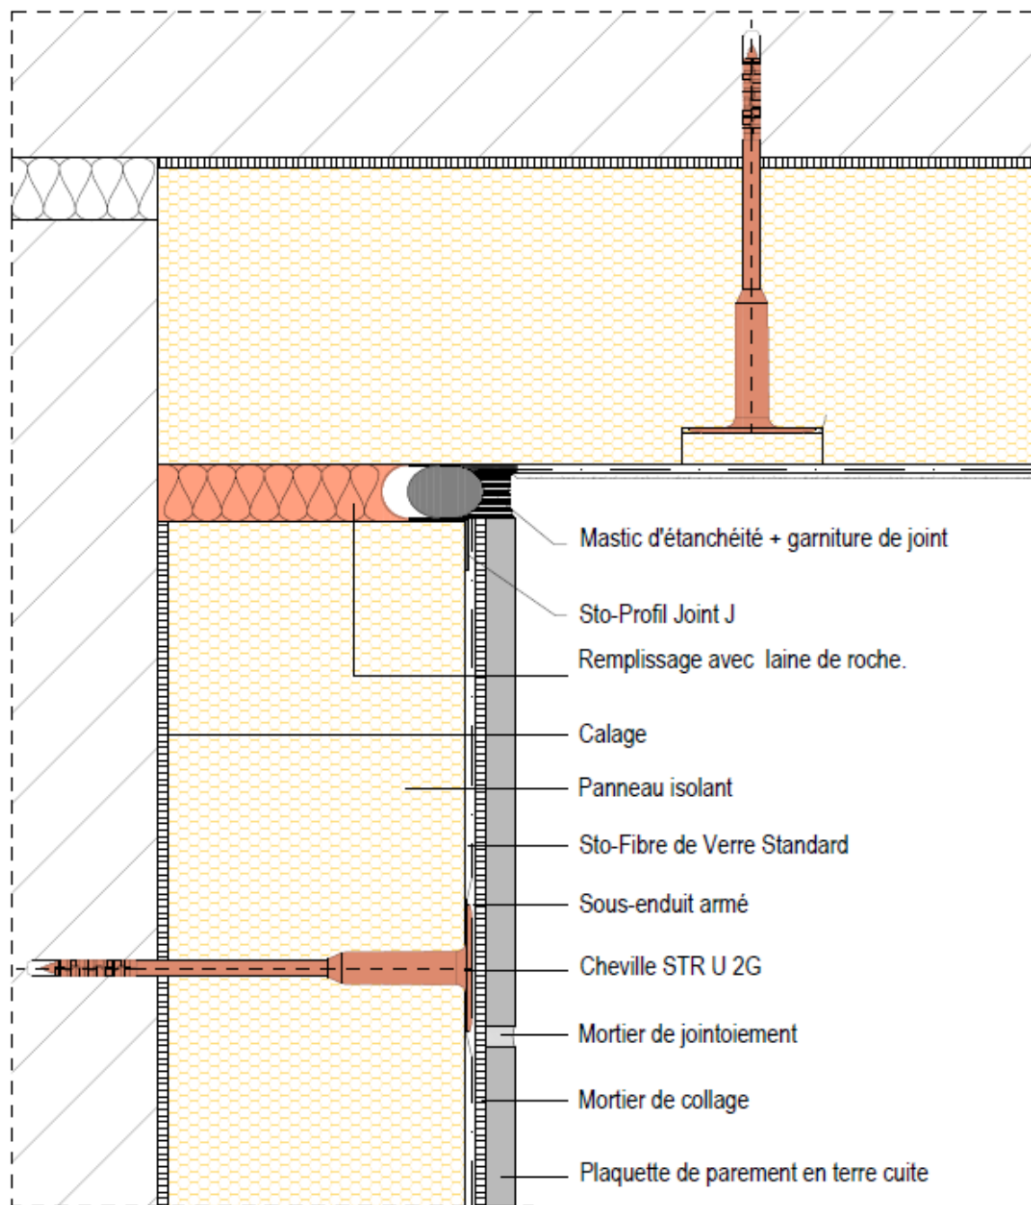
Chevillage à travers la couche d'enduit armée
